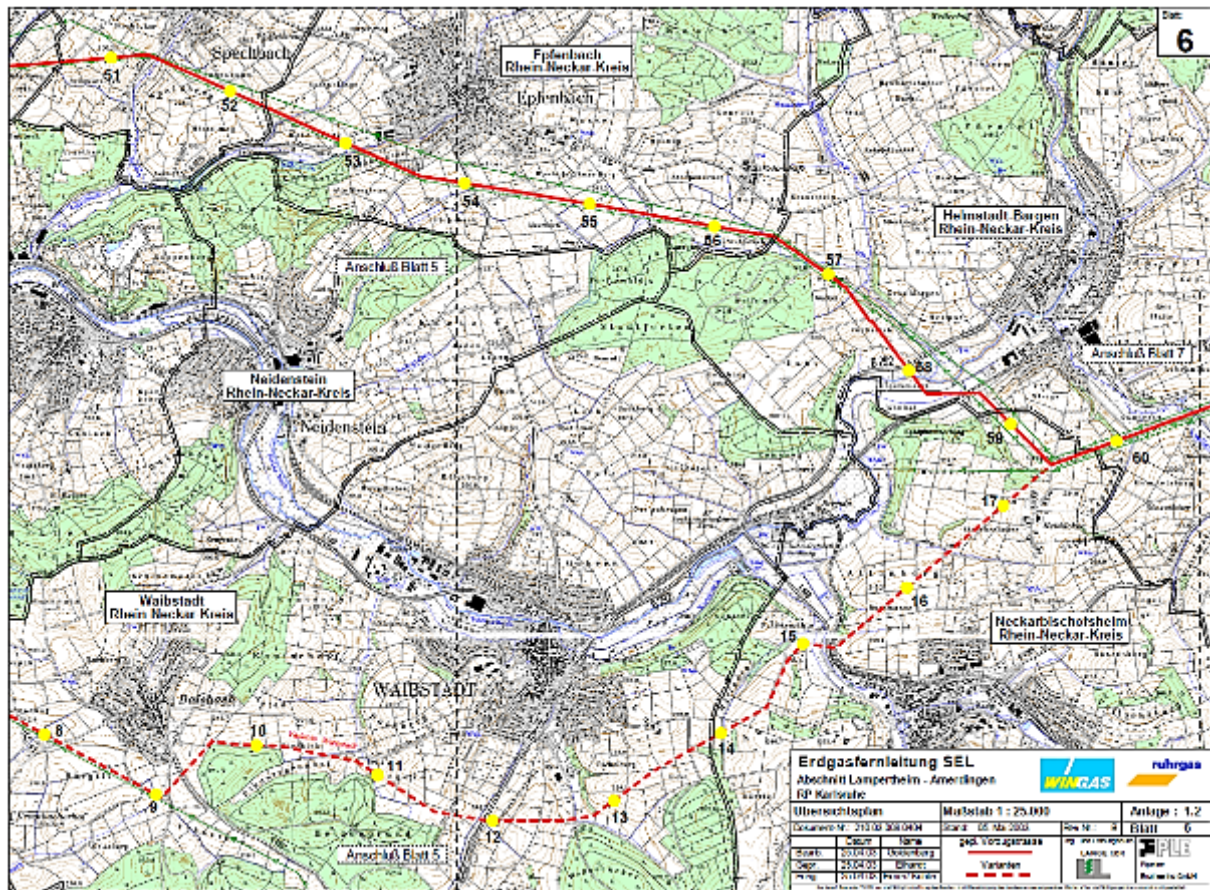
Lageplan Variante Waibstadt – Blatt 1 (Quelle: ROV)
